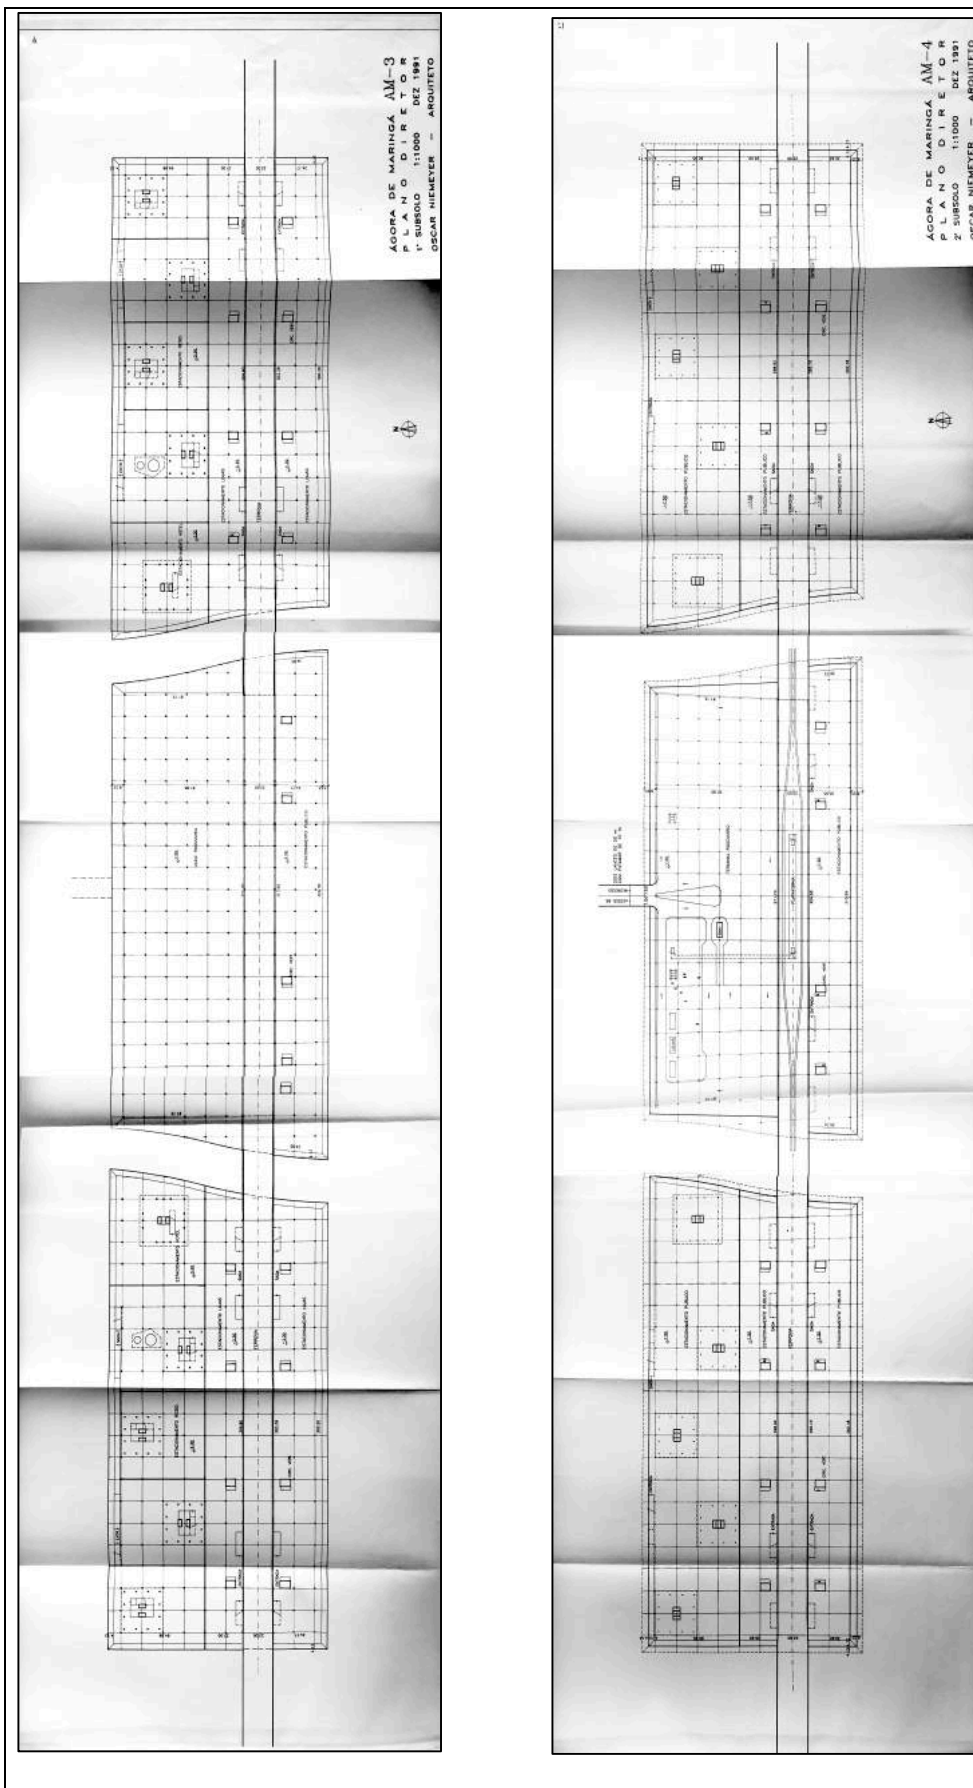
Plantas dos do primeiro e segundo subsolo do Projeto Ágora de 1991.
